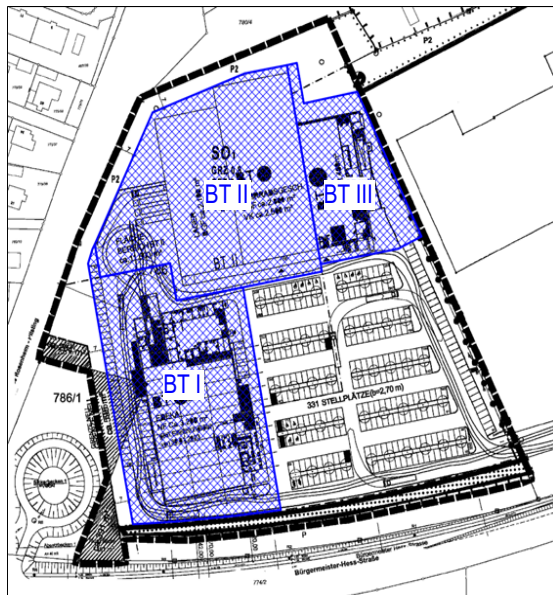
Lageplan mit Darstellung der Emissionsbezugsflächen S_{EK} (ohne Maßstab) Abbildung 2: Lageplan mit Darstellung des Bezugskordinatensystems (ohne Maßstab)
